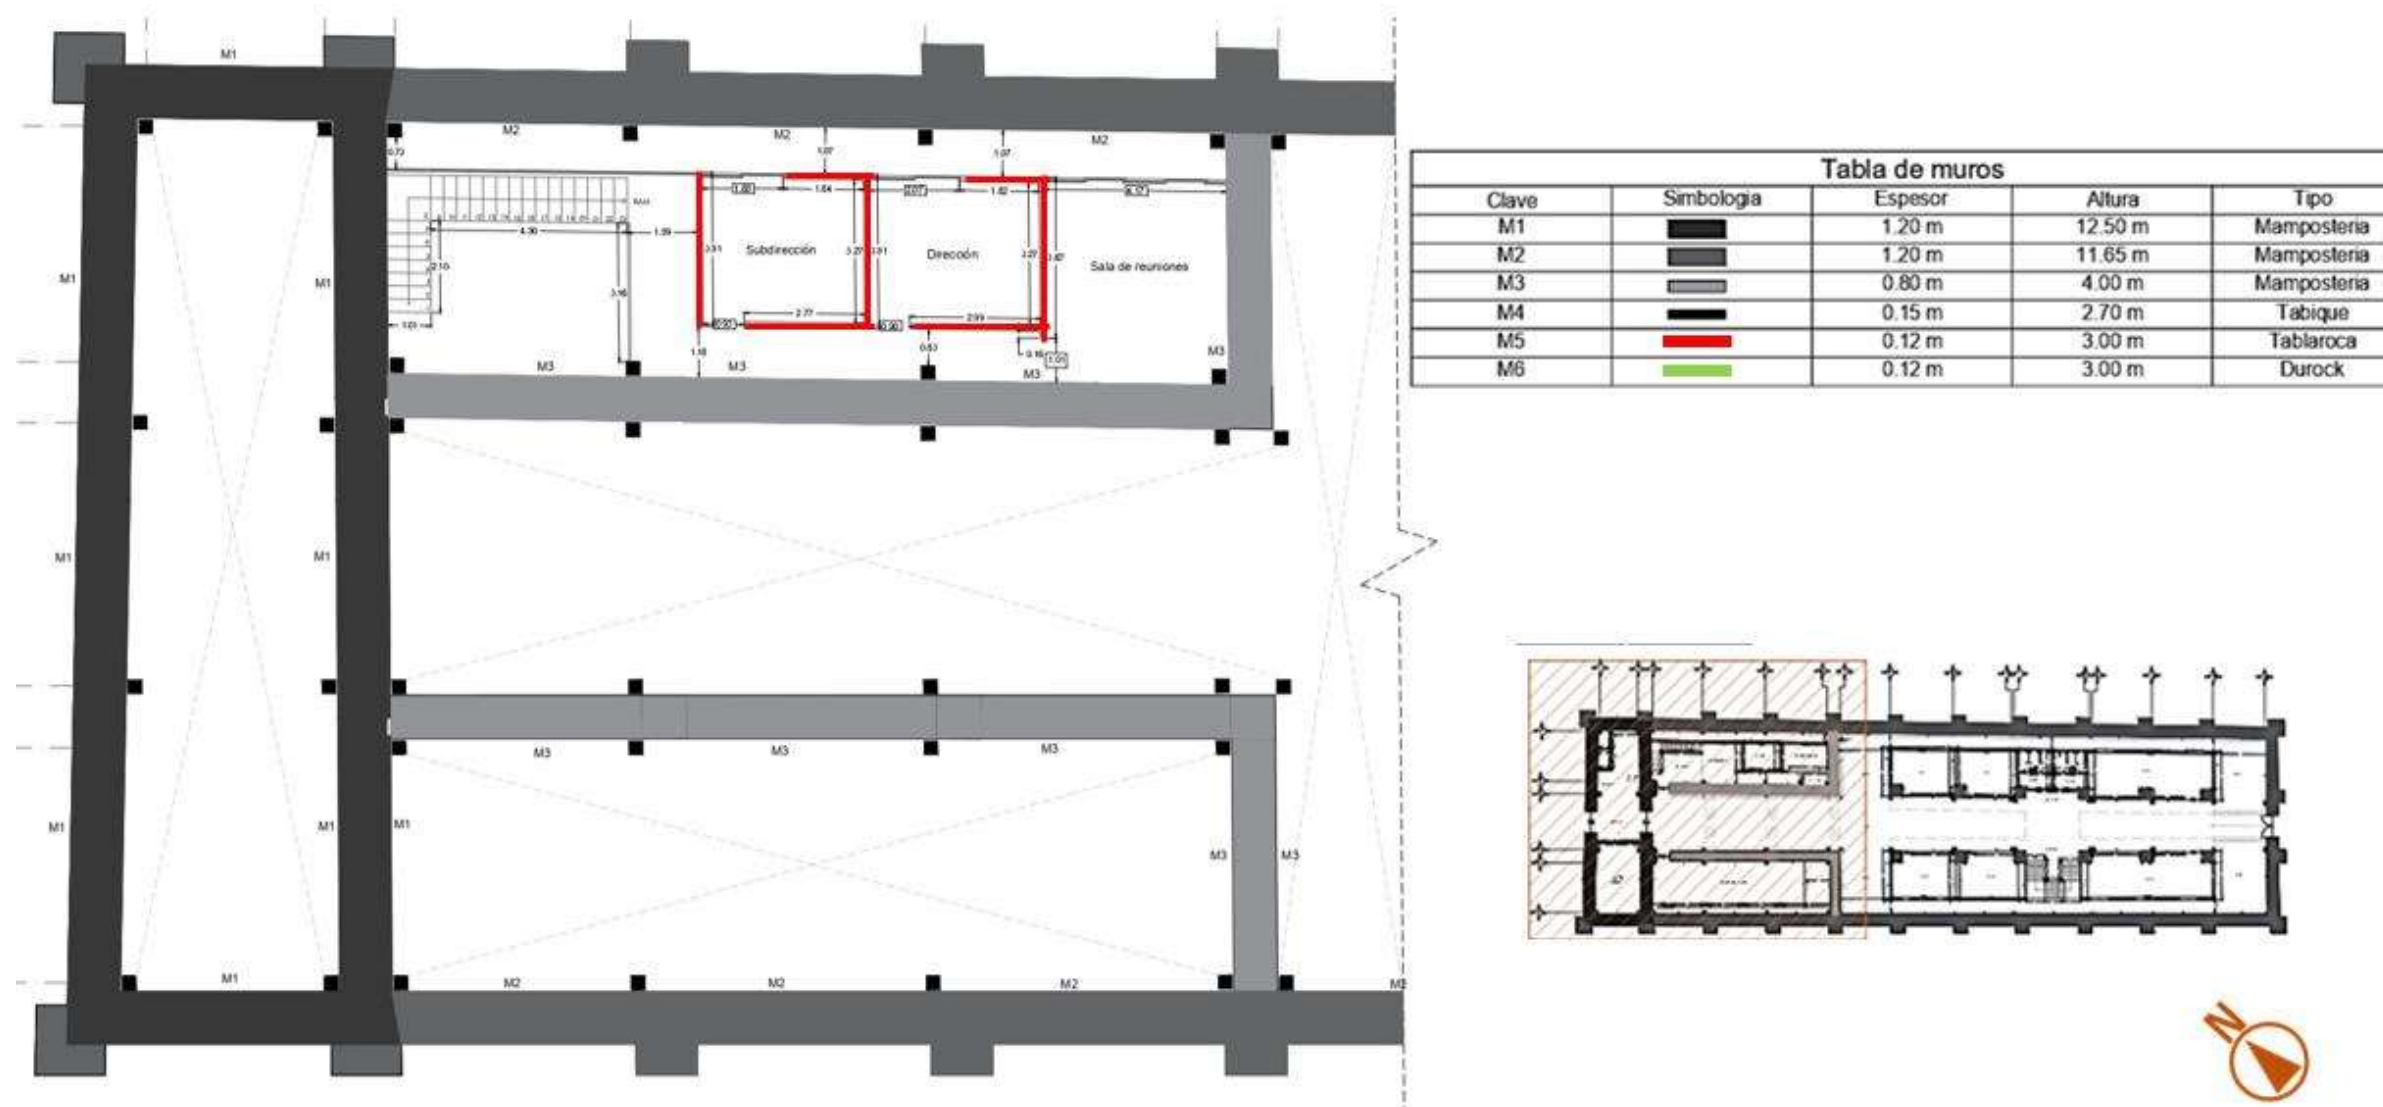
Planos de albañilería 3. Fuente: Elaboración propia.
